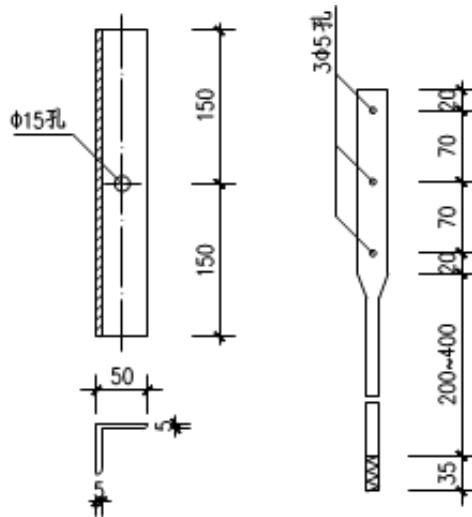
木墙揽连接做法 (单位: mm)
